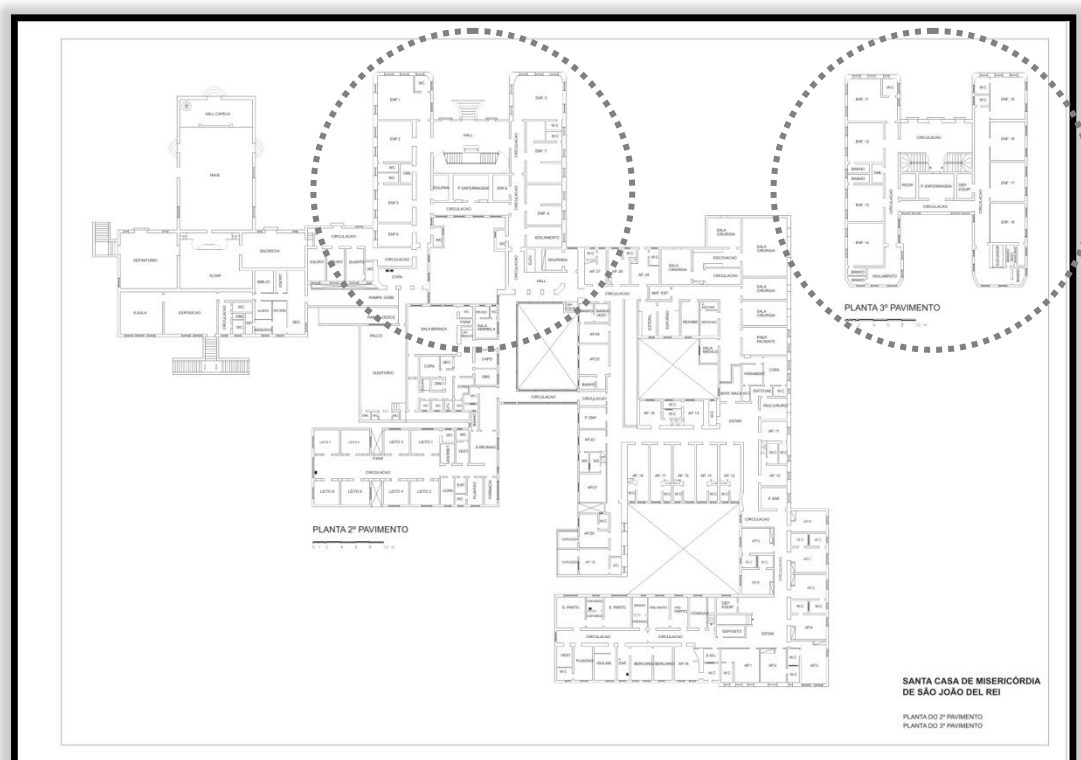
Plantas do 2º e 3º Pavimentos
